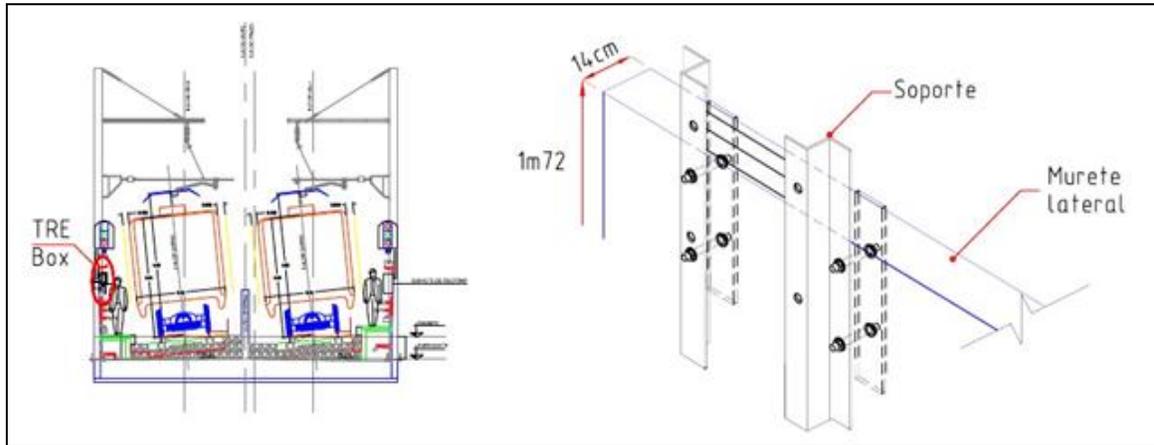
17. Soportes para cajas telefónicas a muro dentro de túneles del metro. Plano realizado en AUTOCAD 2010. Archivo interno de DIMITEC.
